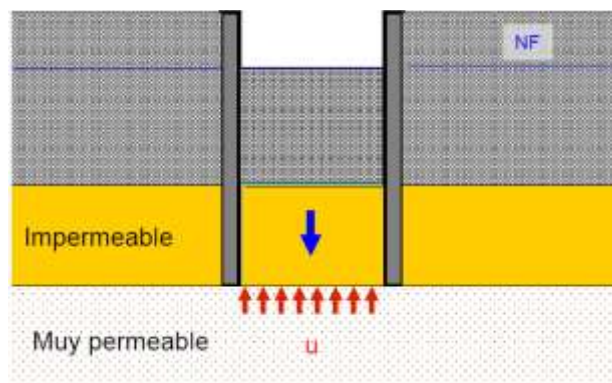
Levantamiento del fondo. Fuente: Asignatura de Diseño geotécnico de cimentaciones y muros
